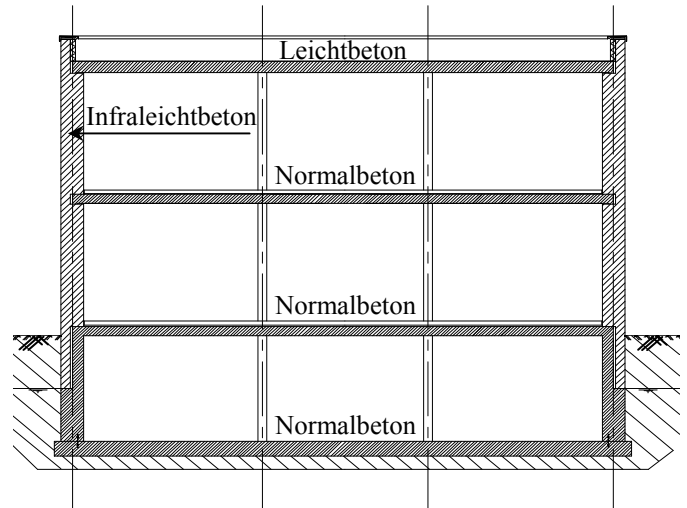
Aufbau eines Sichtbetonhauses aus Infraleichtbetonaußenwänden
